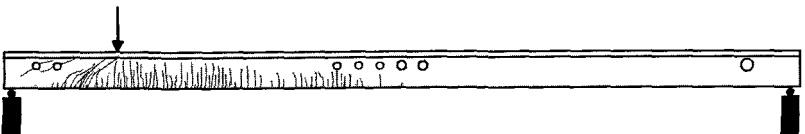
Rissbild Balken G16 nach dem Schubversuch
